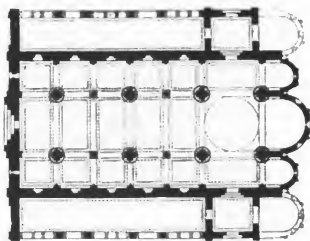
Grundriss von S. Millan zu Segovia.
